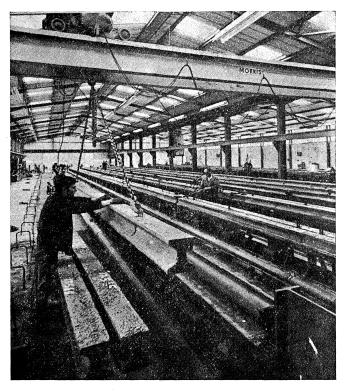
Fabricación de vigas pretensadas en la factoría de St Neots.
